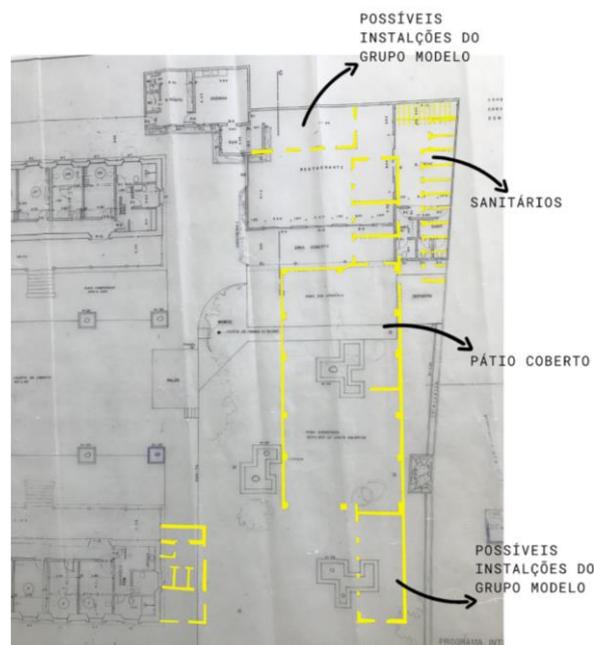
Trecho da Planta Baixa com a localização dos banheiros internos, o mesmo existia do outro lado do edifício.
